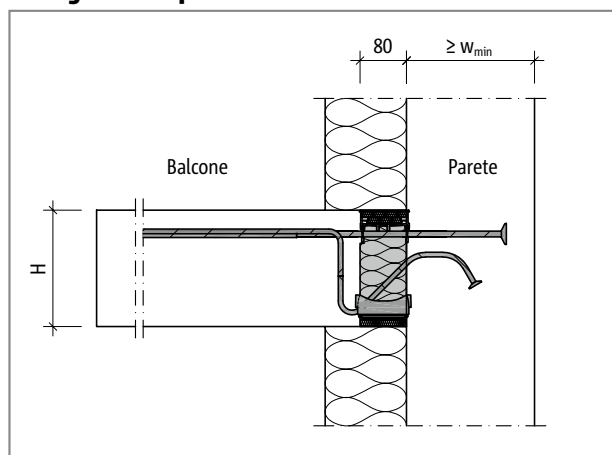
Schöck Isokorb® T tipo KL-U: raccordo al piede della parete con isolamento esterno
